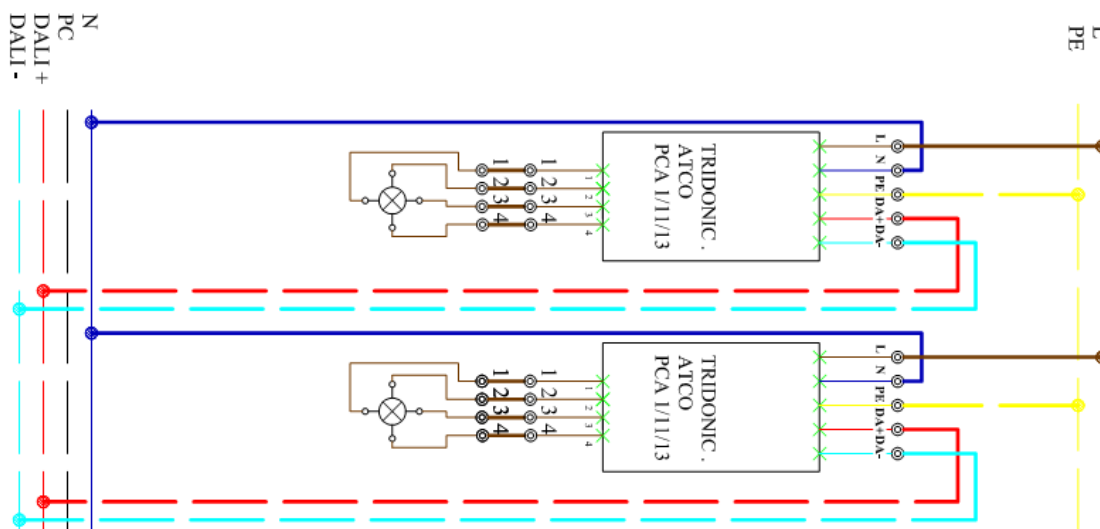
Laboratorní návod 3 - Princip zastoupení stálých světél
